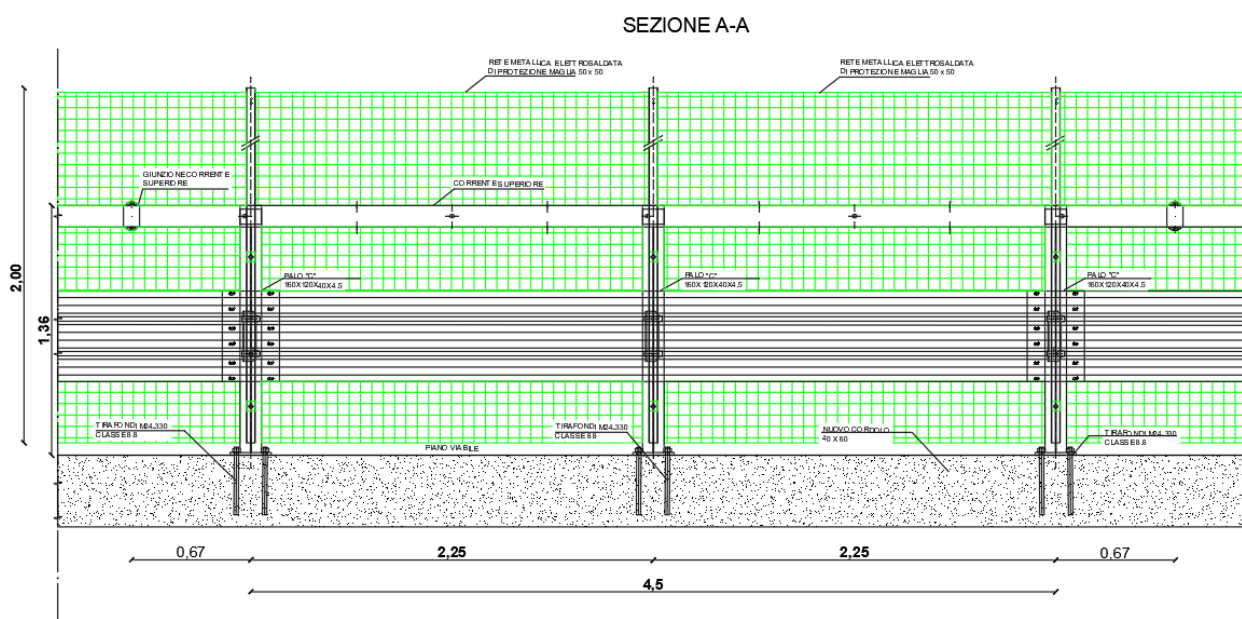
Barriera tipo H2 bordo ponte con nastro a tripla onda
